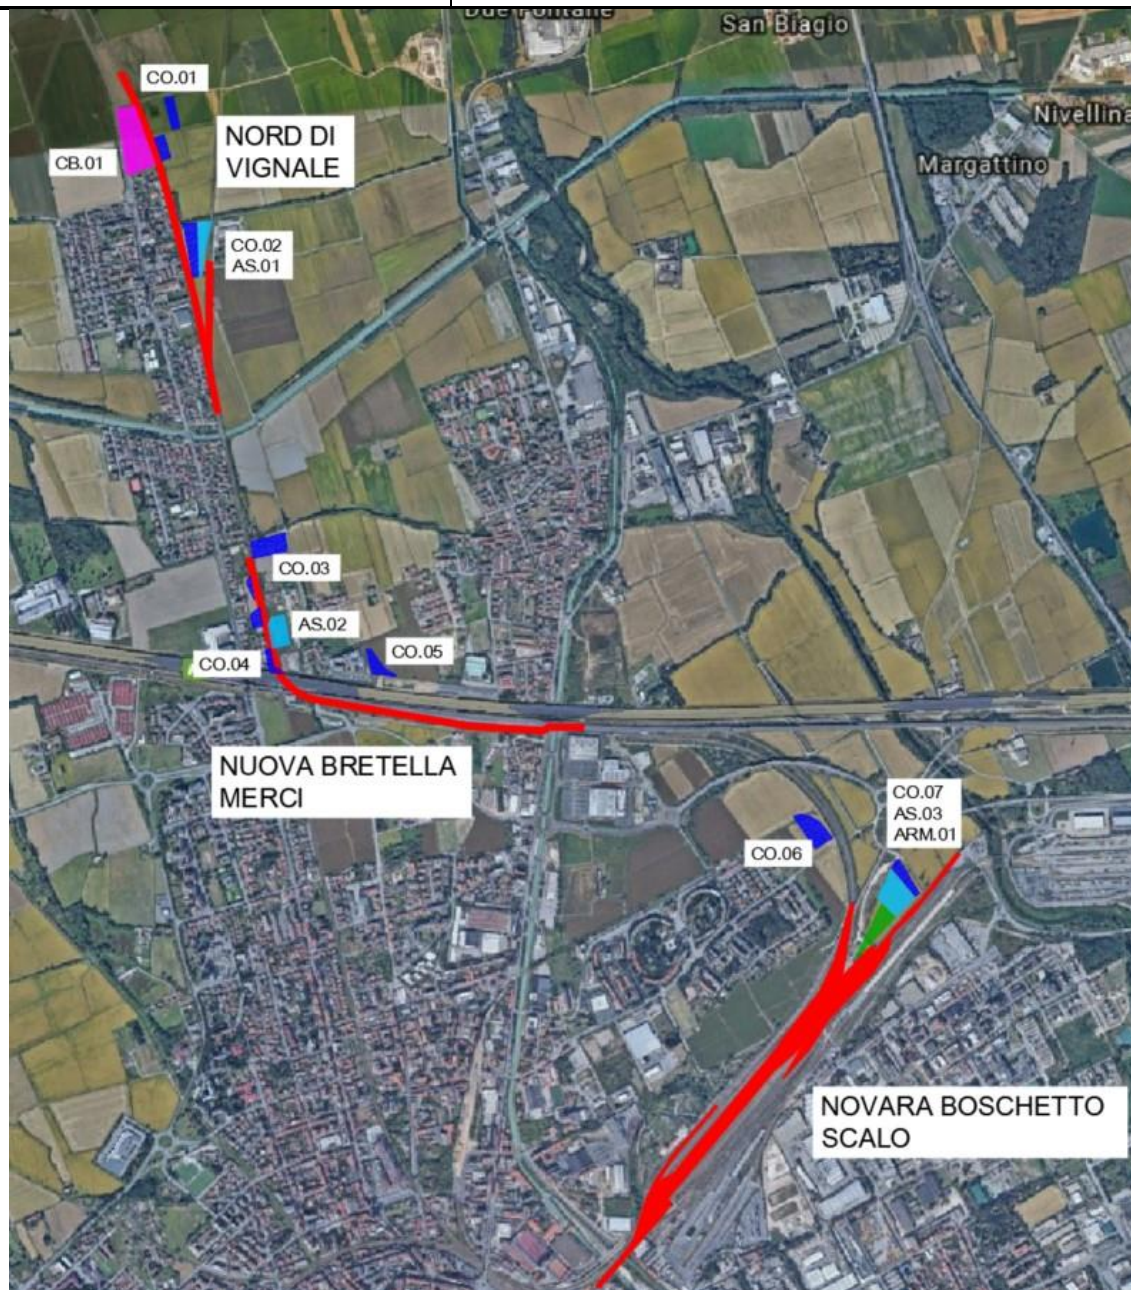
POSIZIONE PLANIMETRICA CANTIERI OPERATIVI
